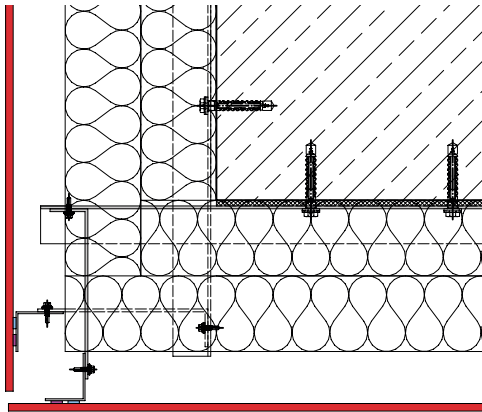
DETAILS KLEBEBEFESTIGUNG AUF METALLUNTERKONSTRUKTION
